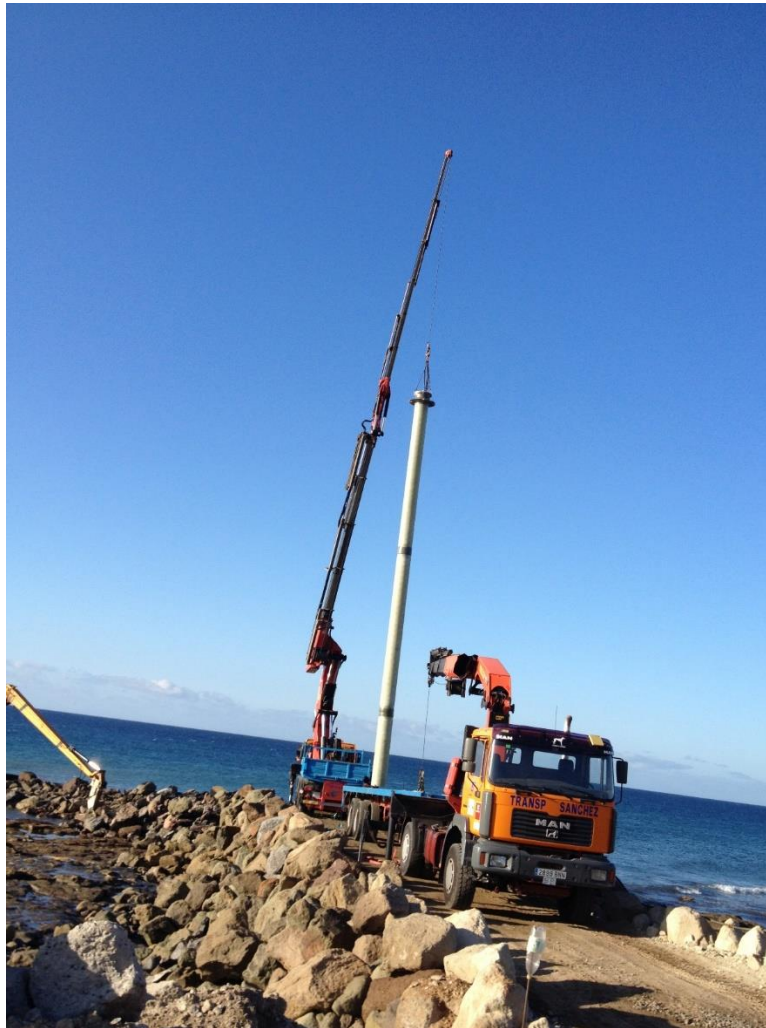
Colocación de la tubería del Sondeo de Conexión a la Galería 1.
